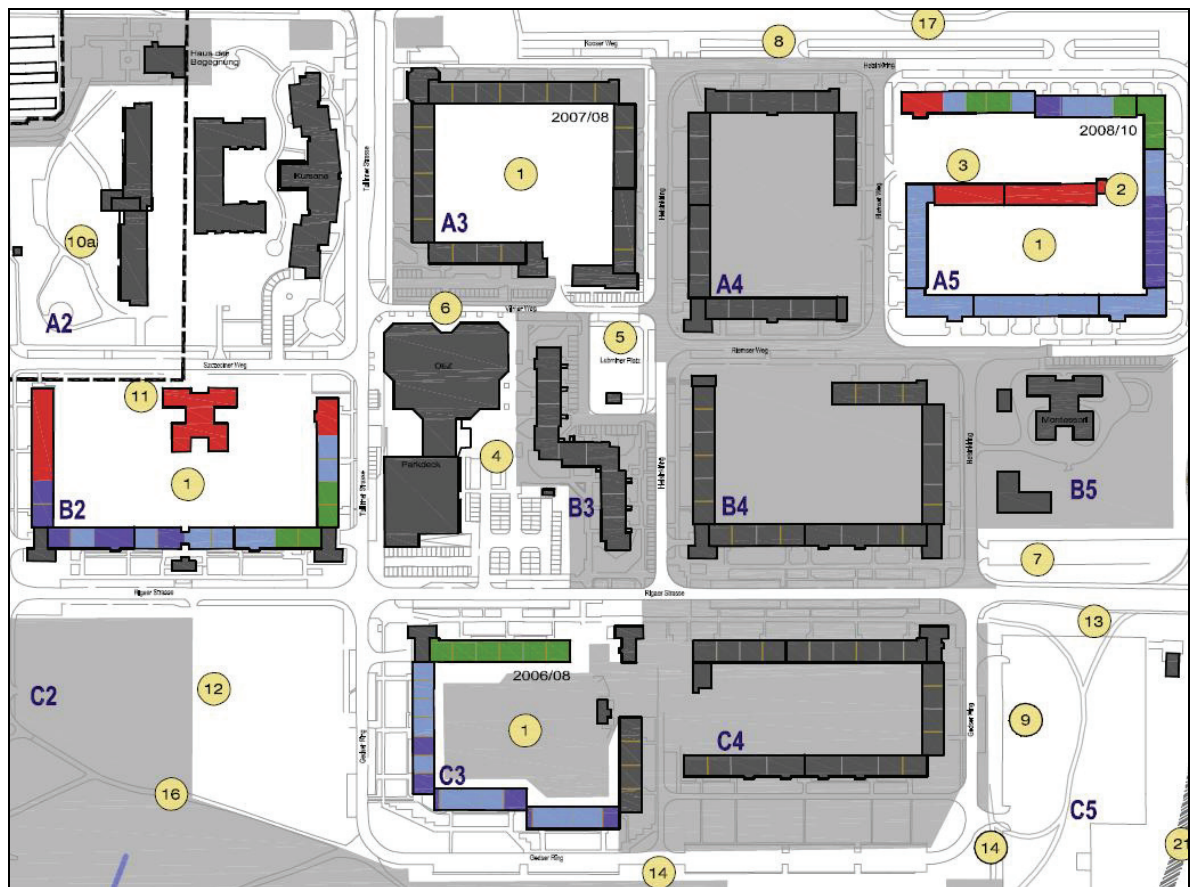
Übersichtsplan Quartiere im OV-PS (Grau bereits fertig, Rot Gebäudeabbruch, Blau Rückbau von 1-2 Geschossen, Grün Umbau ohne Geschossrückbau)<sup>143</sup>
